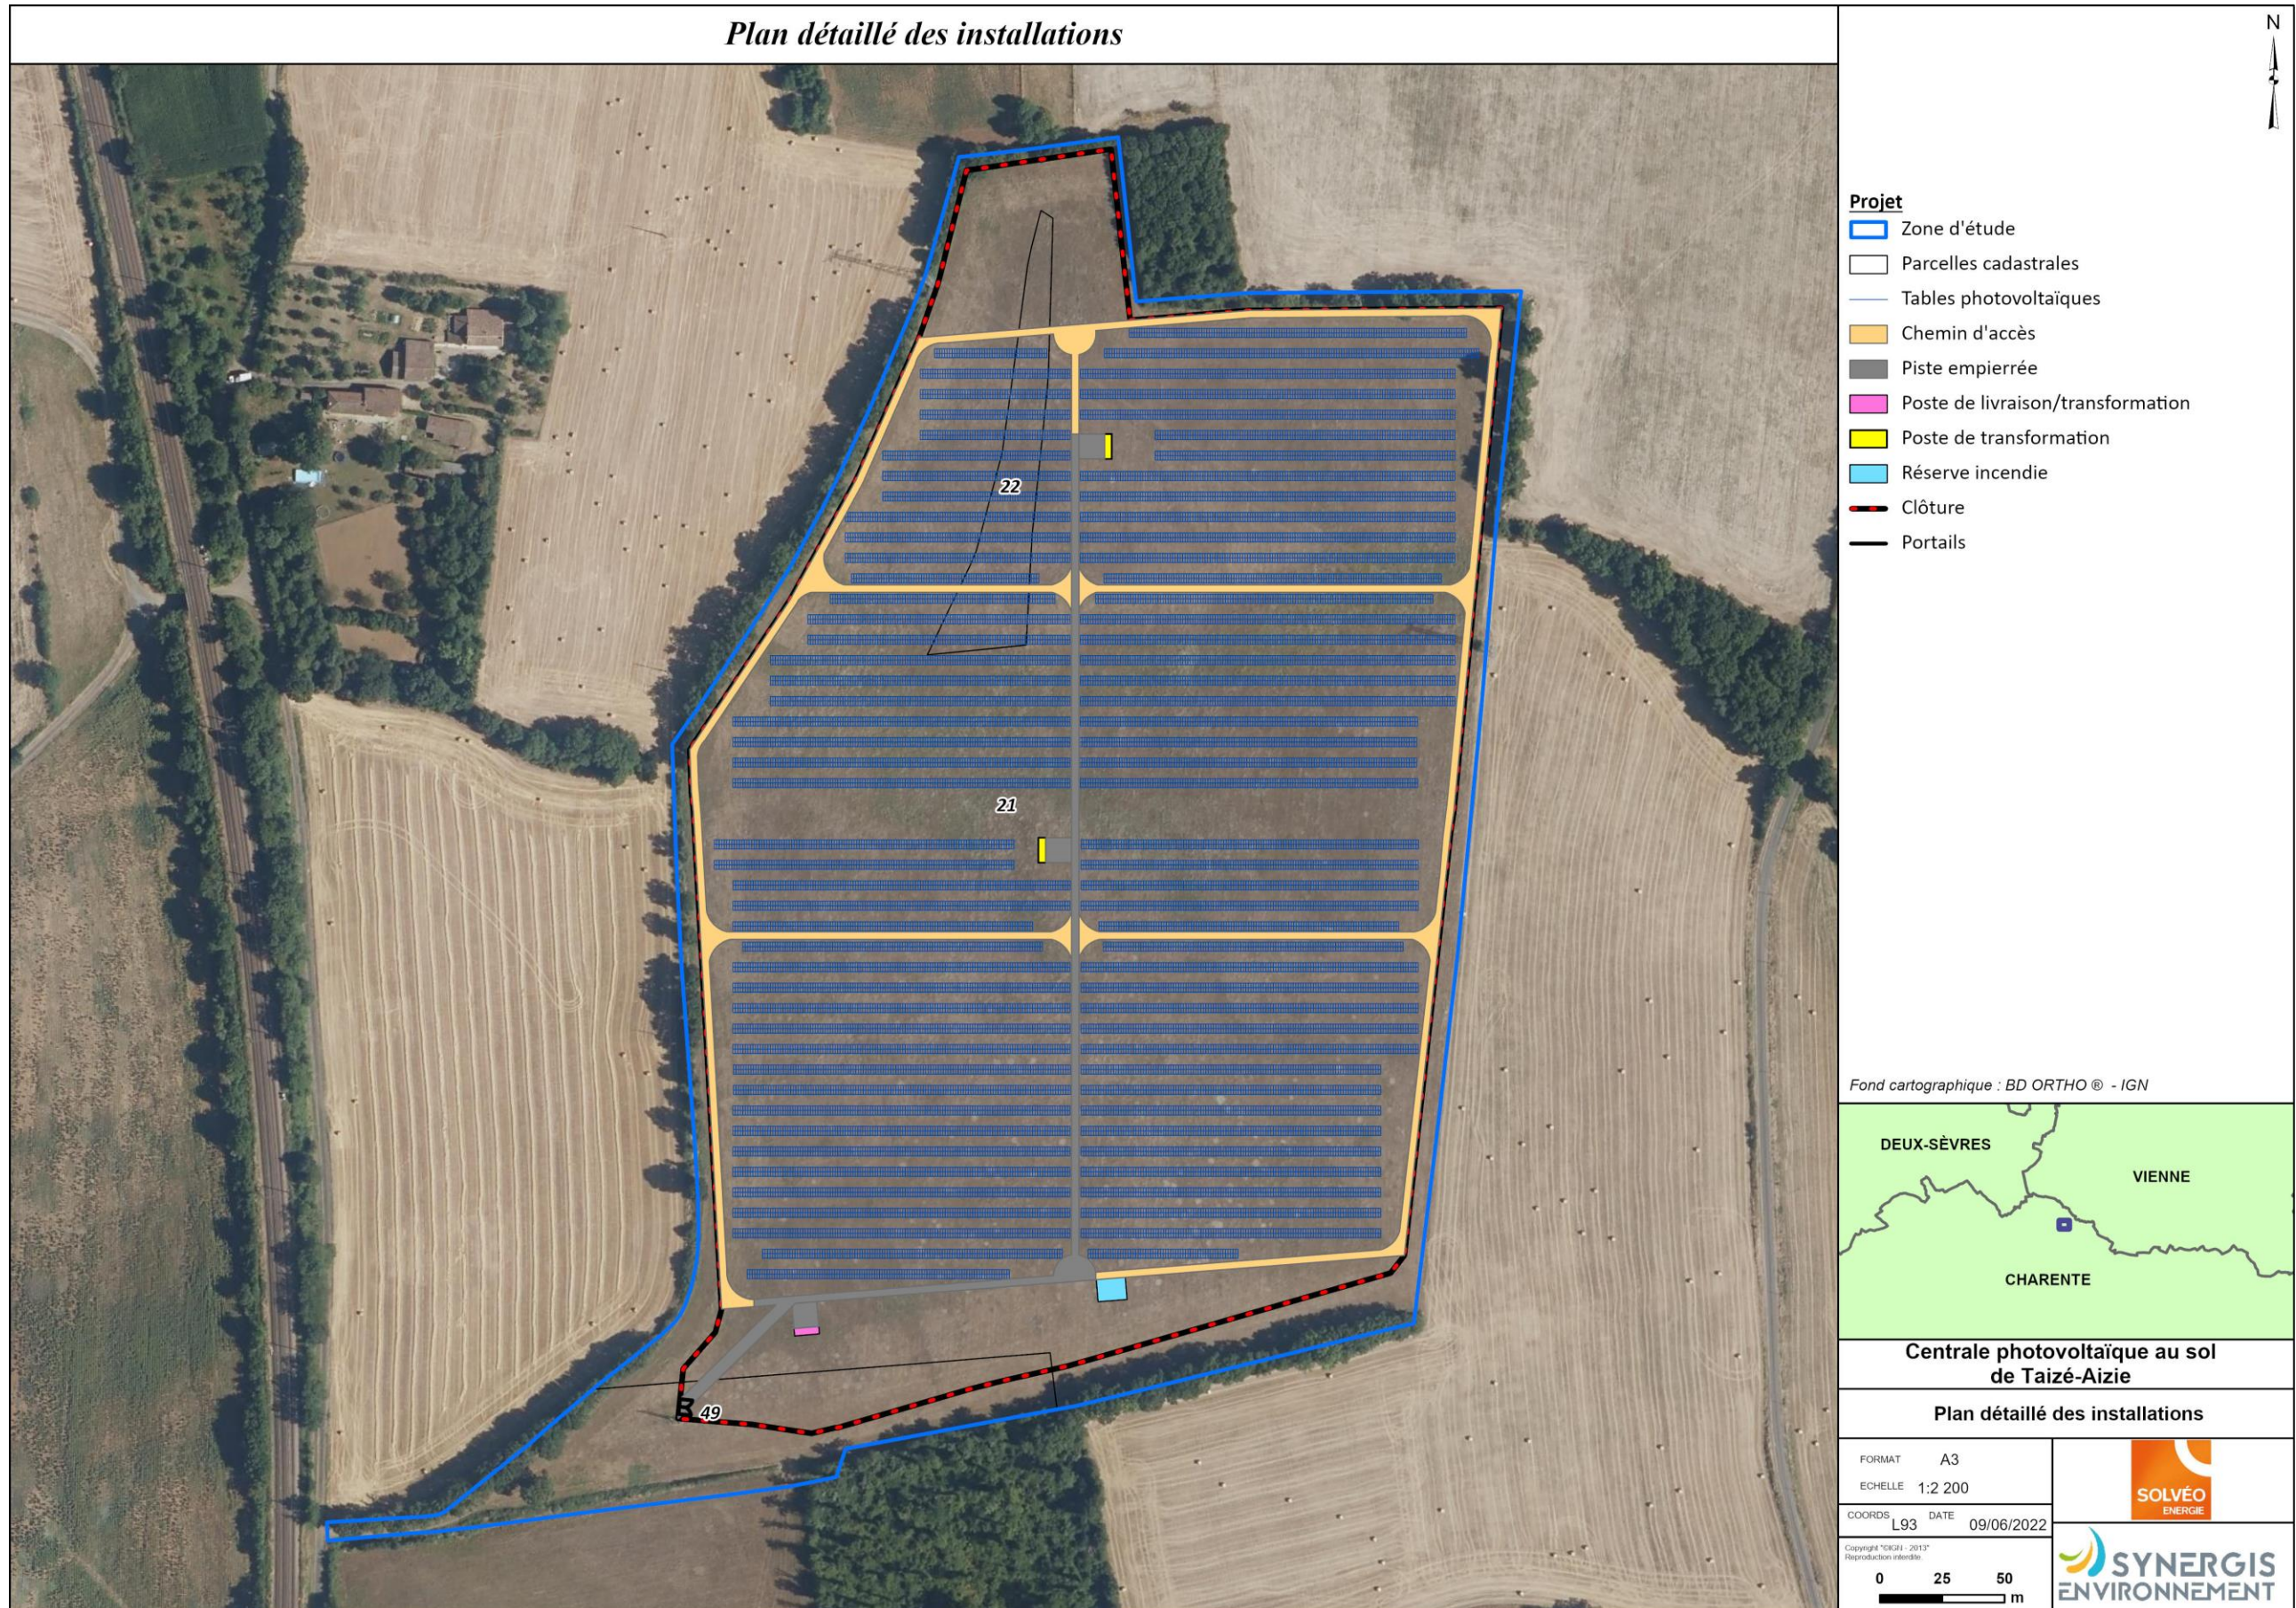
Plan détaillé de l'installation et parcelles cadastrales
